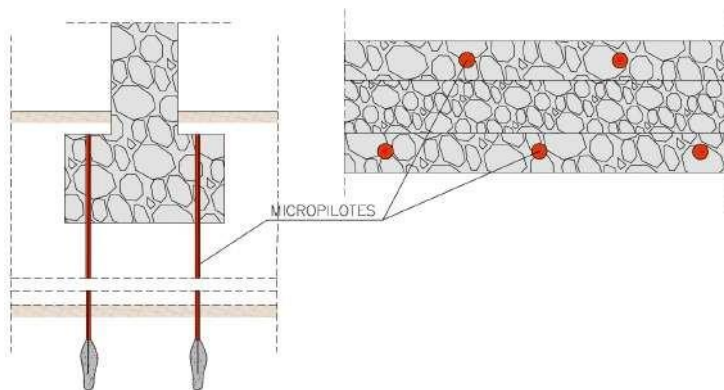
Refuerzo zapata corrida bajo muro. Tipo 1. Micropilotes. Fuente propia
